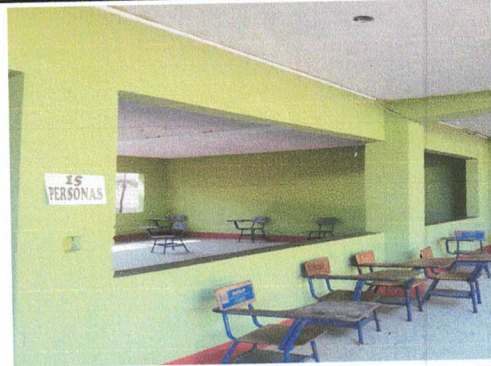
En esta imagen se aprecia el aula número 2, Sustitución del cable eléctrico, tomacorrientes e interruptores en planta baja
